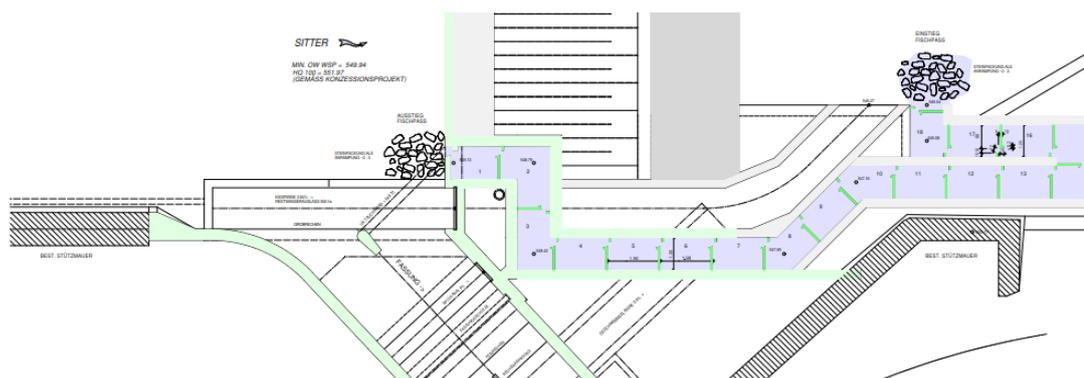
Grundriss des bestehenden konventionellen Schlitzpasses am KW Erlenholz (Quelle: Brauerei Schützengarten AG)
